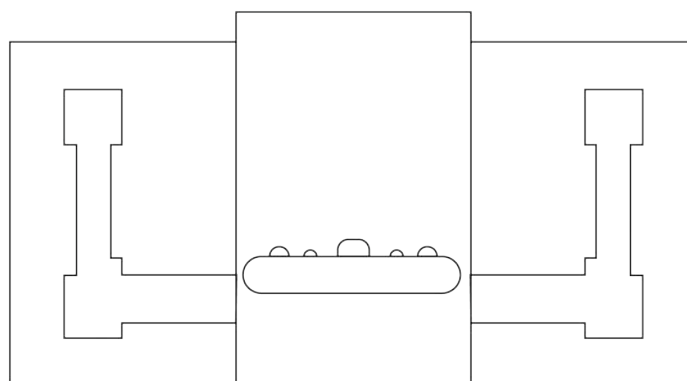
Planta del adoratorio. Al centro la escultura flanqueada por muros pintados.
